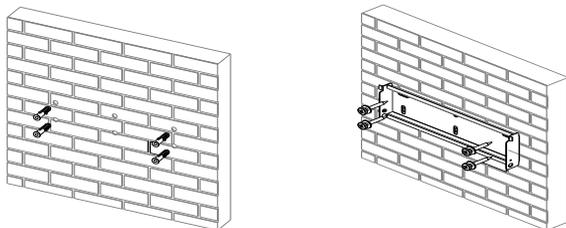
Instalar chumbadores de expansão FIG. 6-8 Fixar o suporte de montagem na parede
